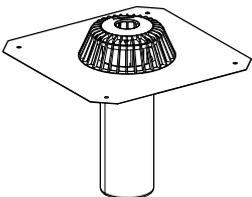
Geberit Dachwassereinlauf mit Anschlussblech
